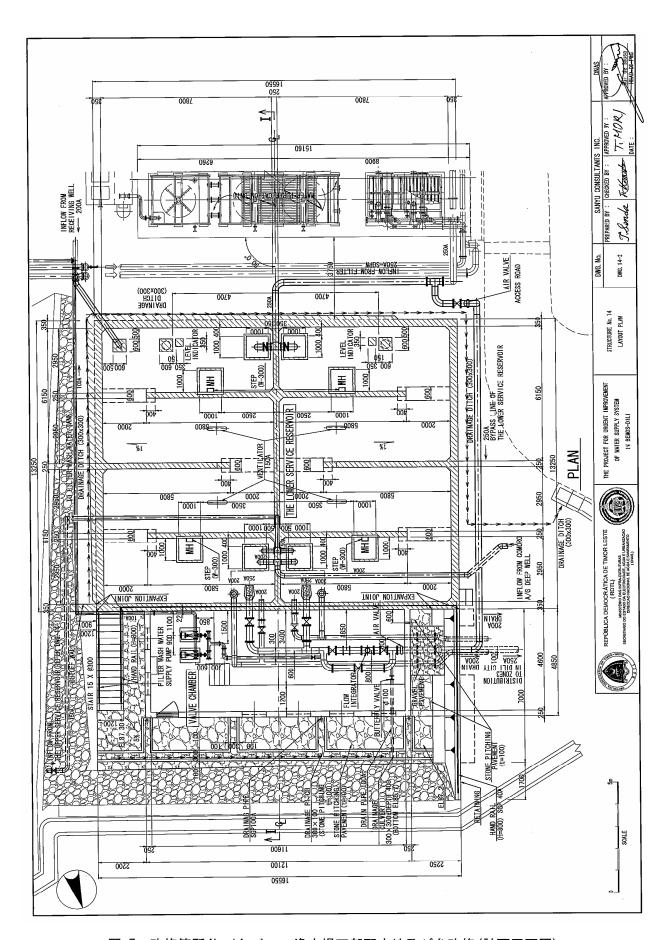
改修箇所 No. 14 ベモス浄水場下部配水地及び弁改修(計画平面図)
